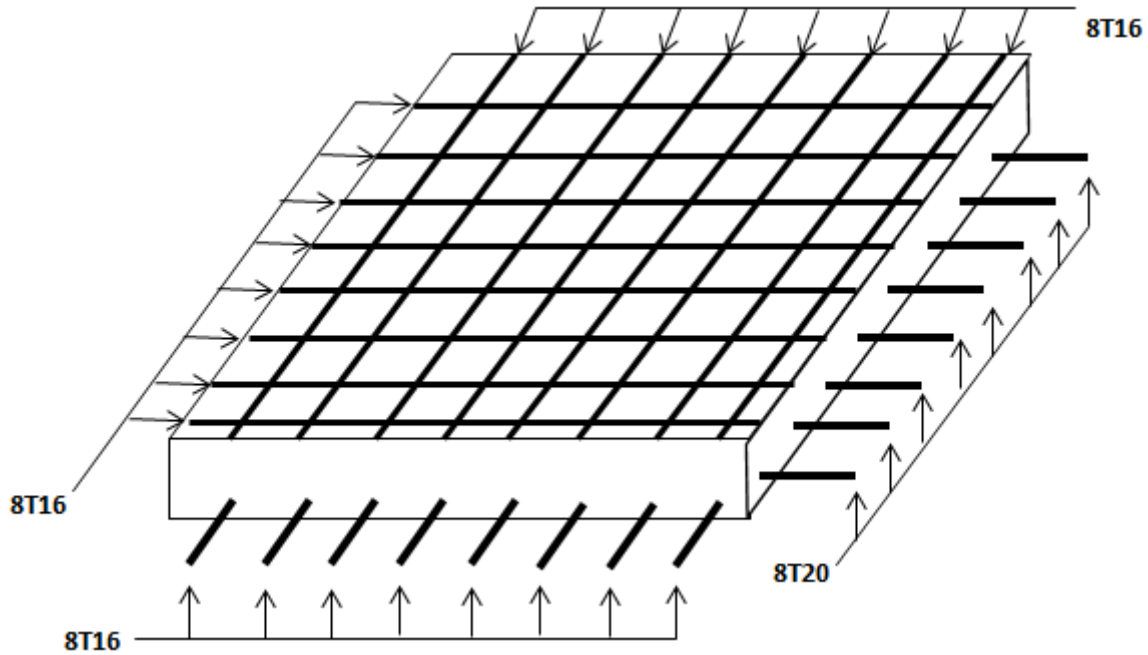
Schéma de ferrailage de la dalle de radier.
